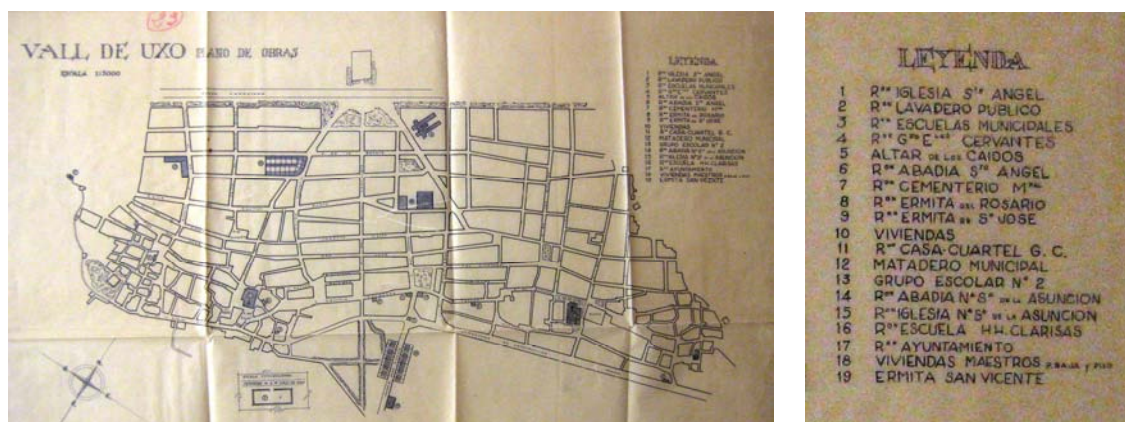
7. LA VALL D'UIXÓ. Plano de obras del plan de reconstrucción de Regiones Devastadas.
